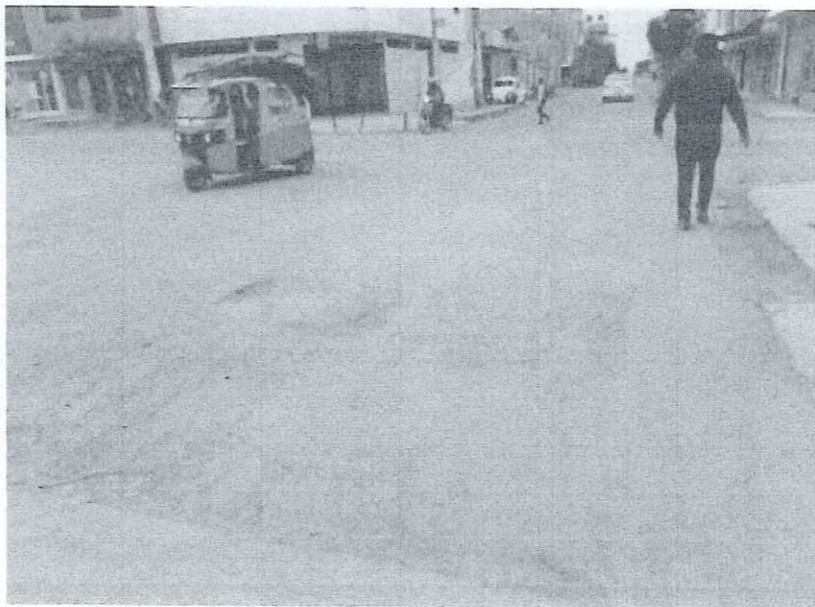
SE APRECIA GRIETAS Y FISURAS EN EL AV. G MANUEL AREVALO II ETAPA ENTRE CALLE 9 -
